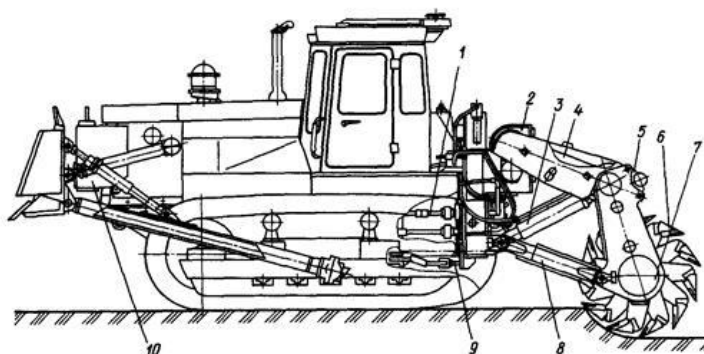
Машина ДП-31АХЛ послойного фрезерования грунта
